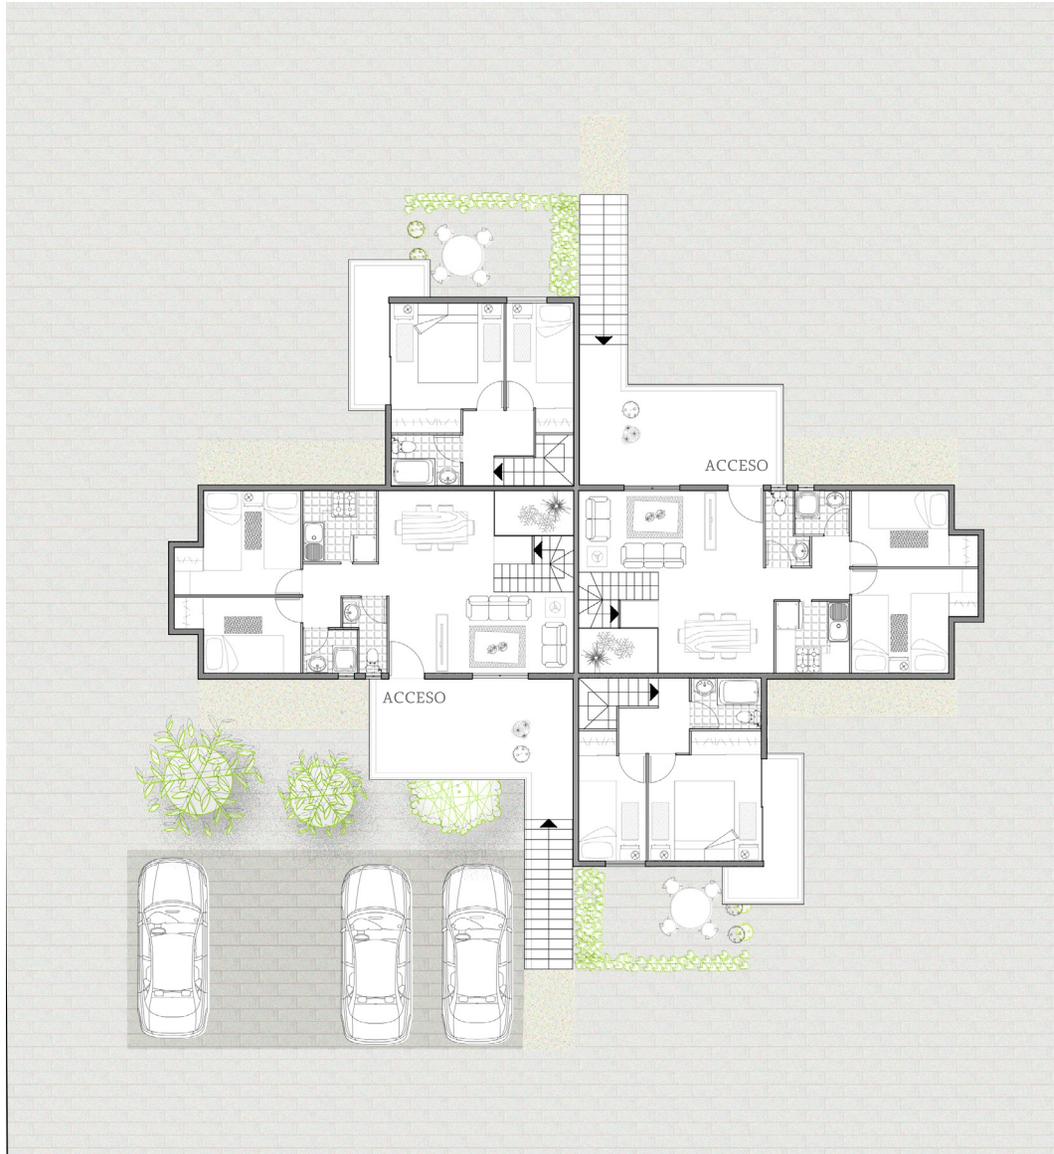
Planta propuesta unidad habitacional, segundo piso, avance proyecto
